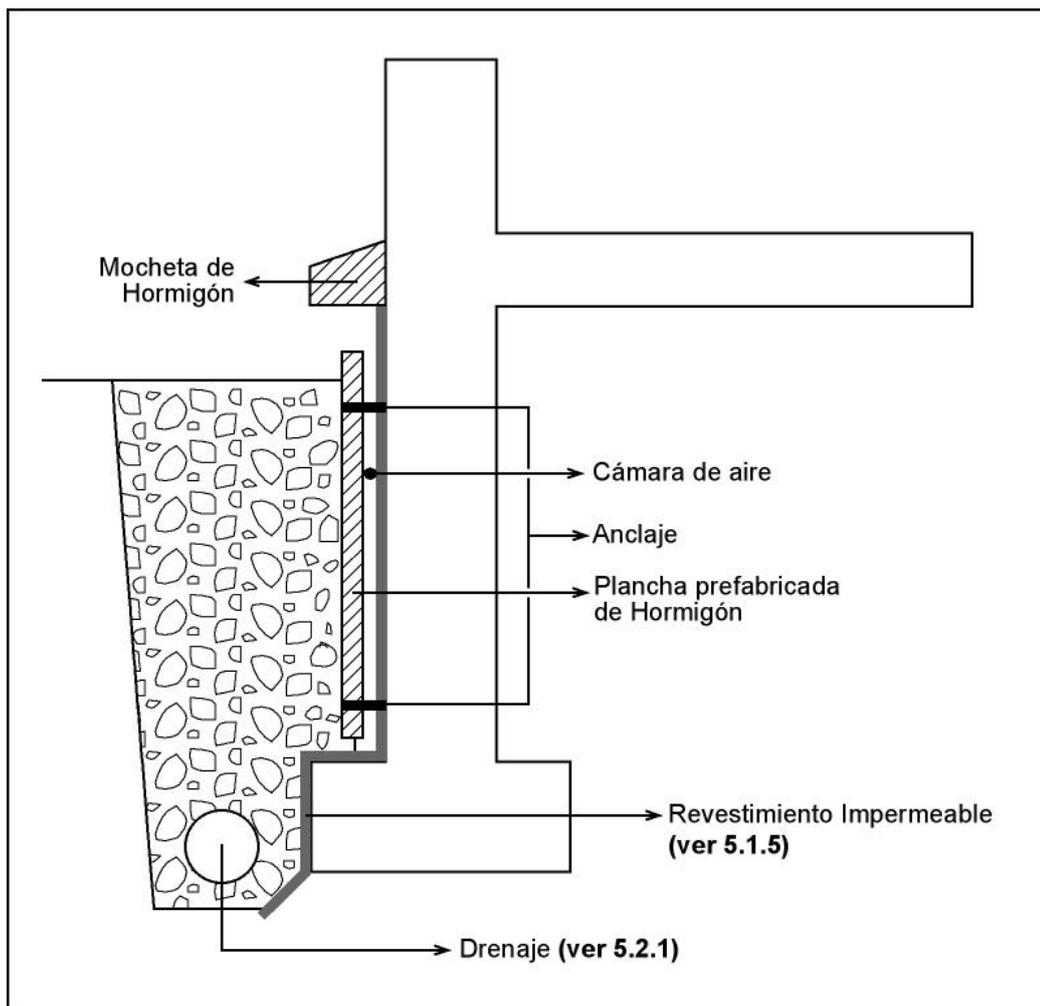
Cámara de aire, drenaje y revestimiento impermeable
